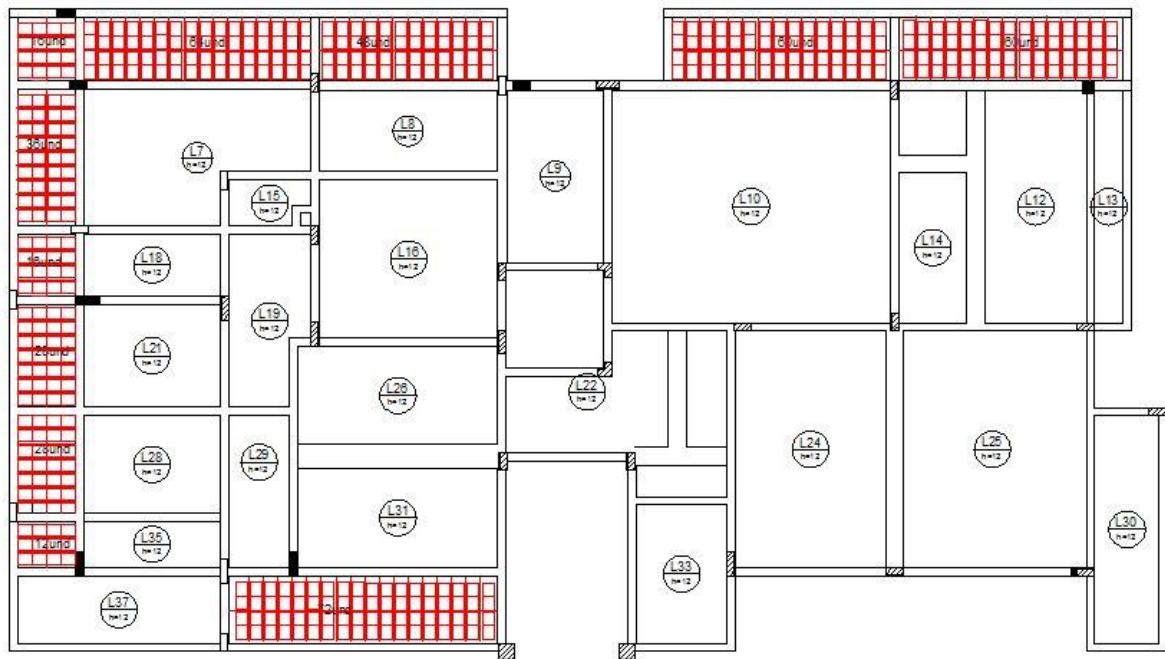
Demonstração da laje conforme projetos, conflitando o arquitetônico
